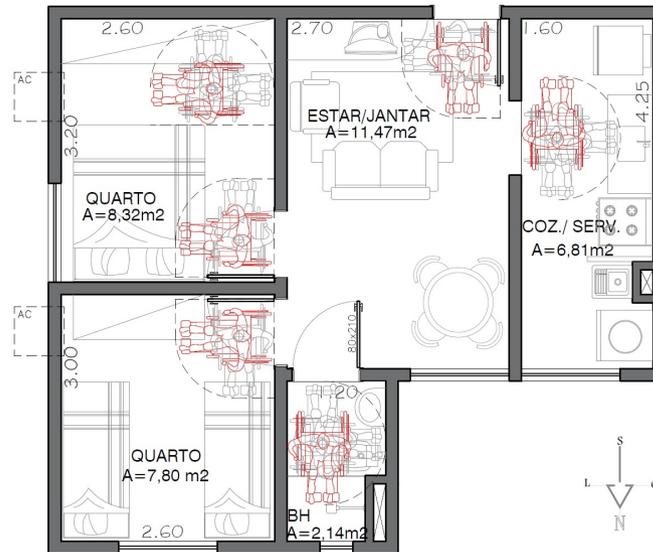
Insolação/ventilação do Pavimento tipo do Residencial Pitangueiras
